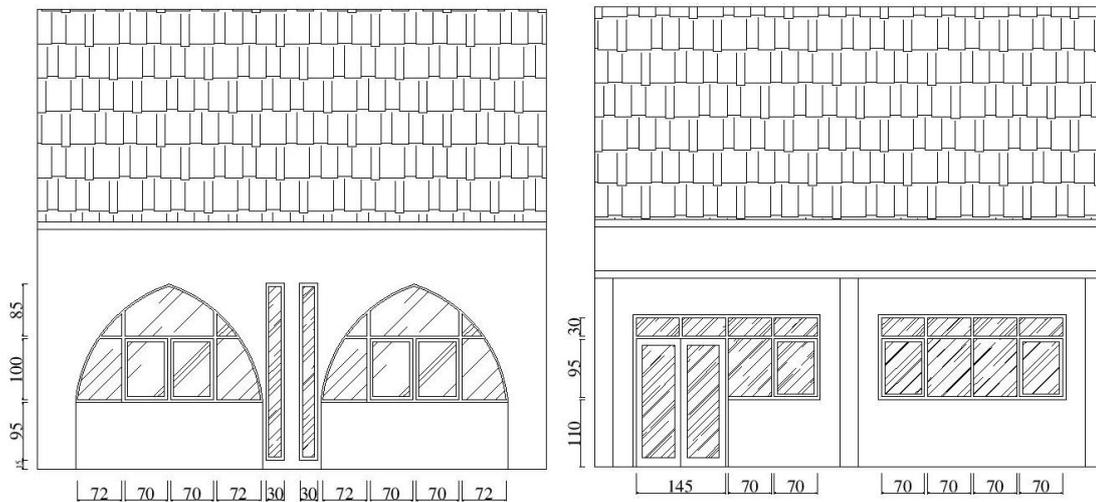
Tampak Tenggara dan Barat Laut Ruang Alternatif 1 Rekomendasi Eksternal I Ruang Kelas IPA IX.
